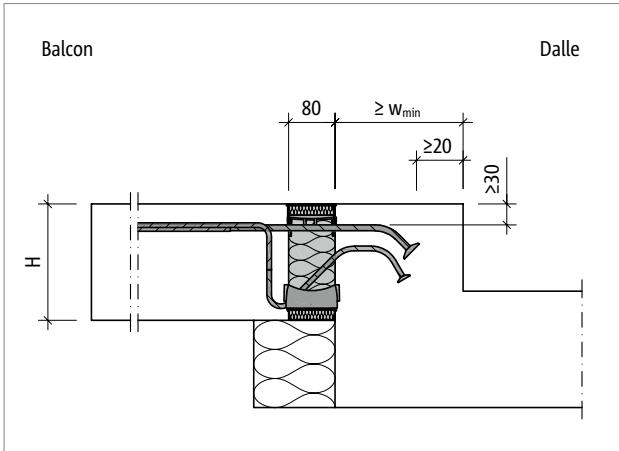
Schöck Isokorb® T type K-O : balcon avec décalage vers le haut et isolation extérieure
